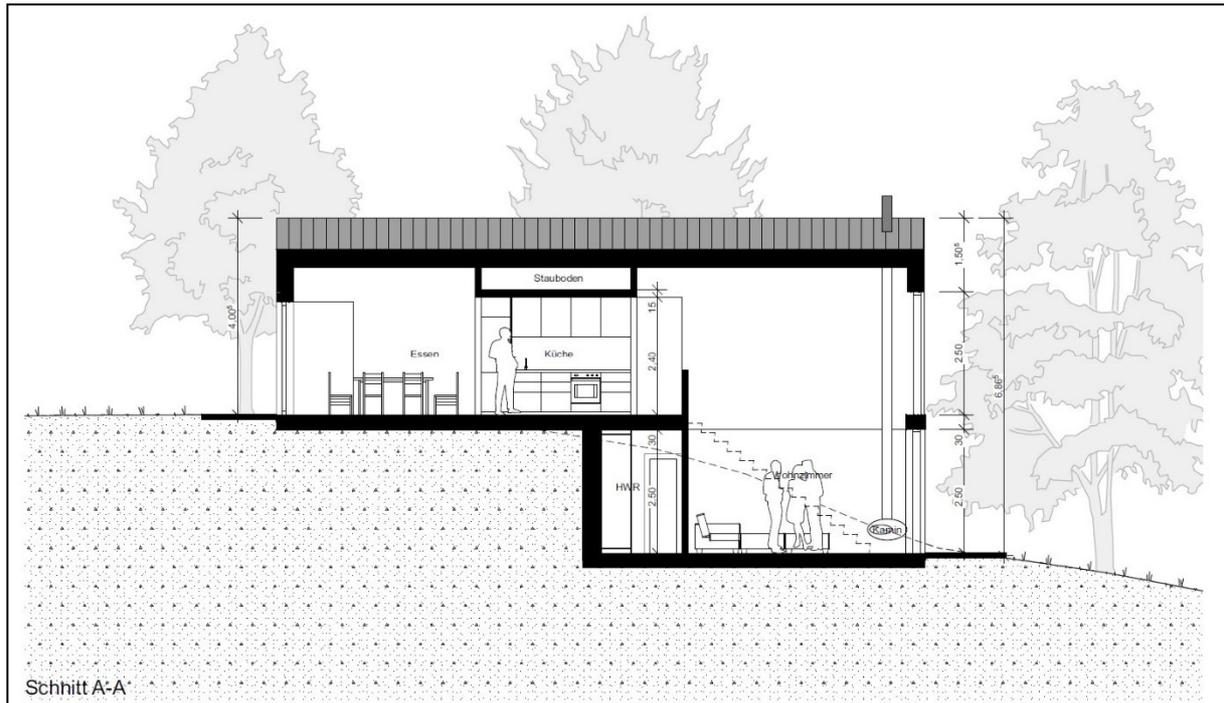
Beispieldarstellung (Schnitt) eines Gebäudes im Baufeld A (Quelle: Begründung zum VB-Plan, Abbildung 6, Abb. erstellt durch urbanplaces Projektentwicklung, 10405 Berlin).
